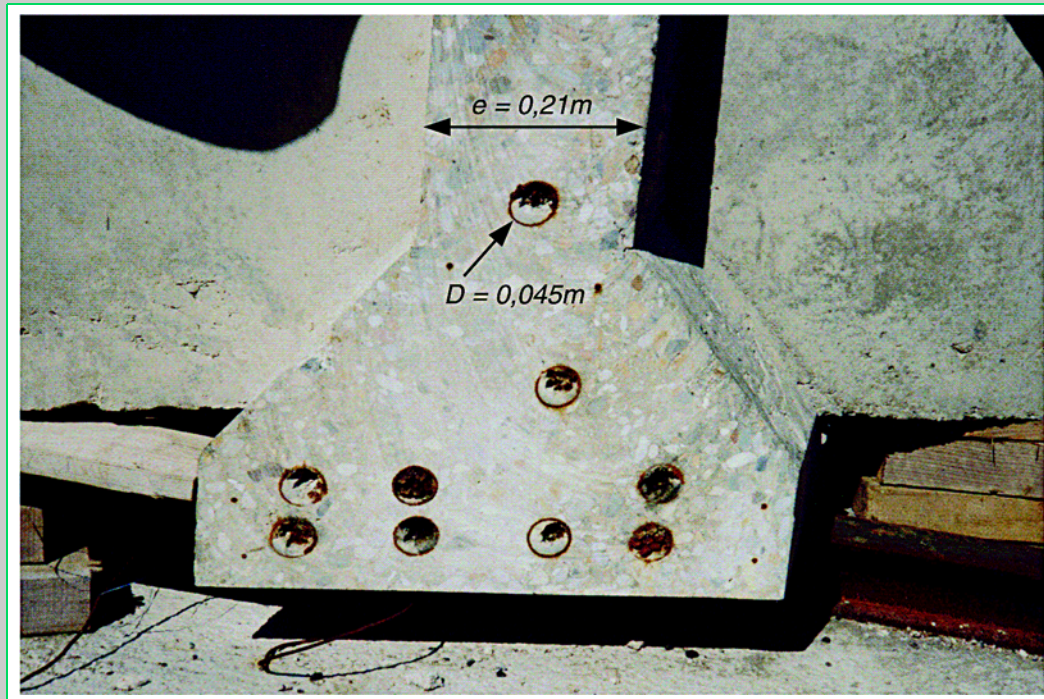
Section de la poutre du Pont Neuf (Foix, France) ausculté.
